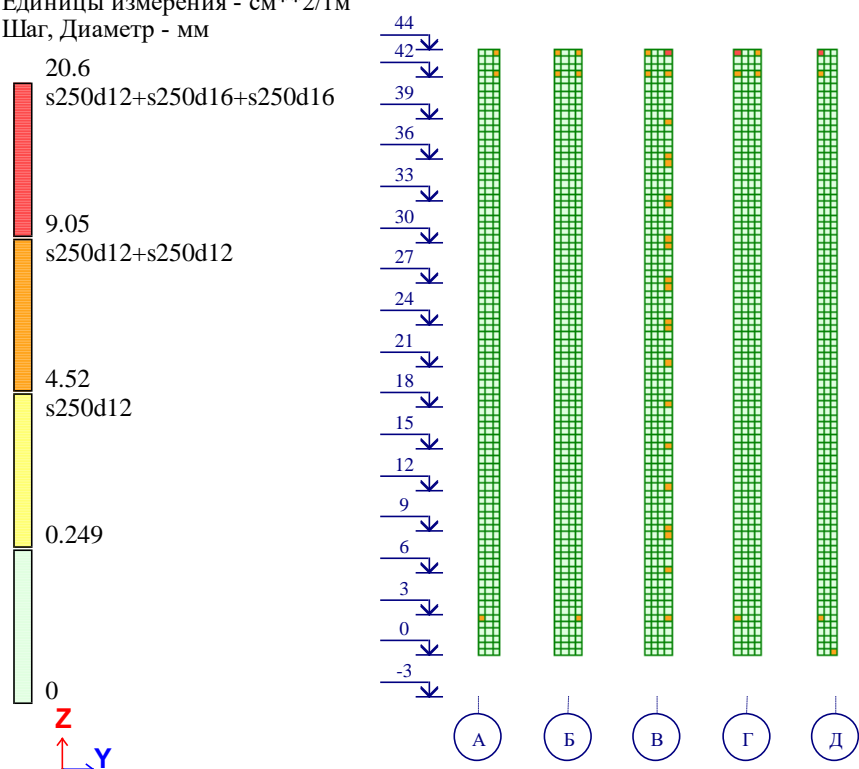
Расчетное армирование стен по оси Y у верхней грани.
